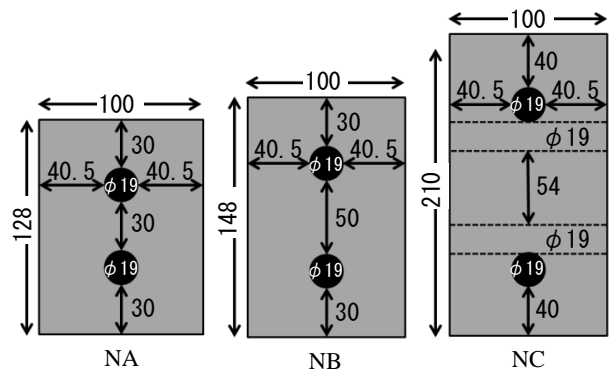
供試体のタイプ別の断面形状・寸法 (mm)
